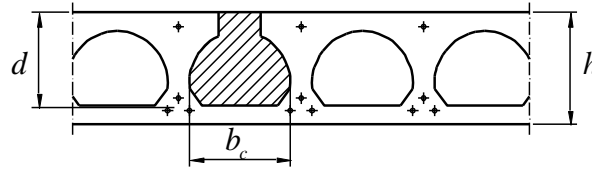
Laje alveolar com alvéolo betonado. EN1168:2005 [8].
